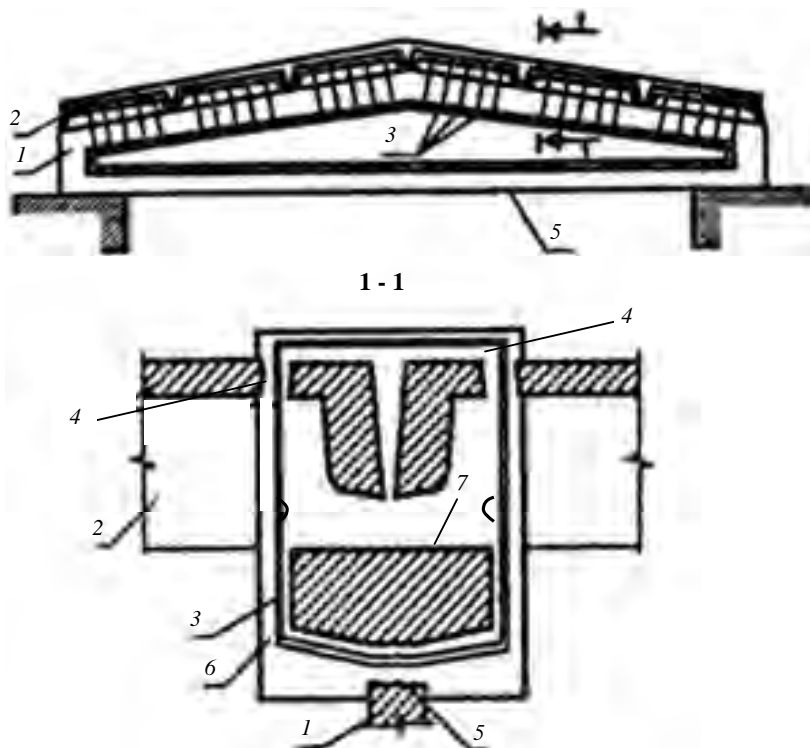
Включение в совместную работу плит покрытия путем устройства железобетонных обойм:
